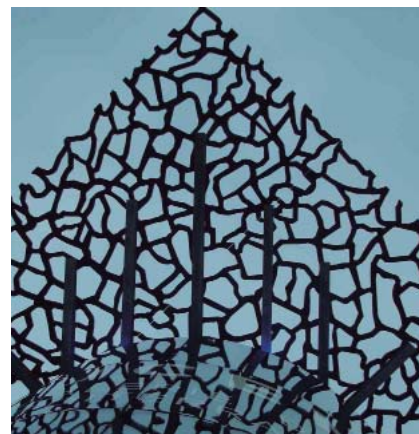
L'UHPC permet construir voladissos amb cantells molt prims.
